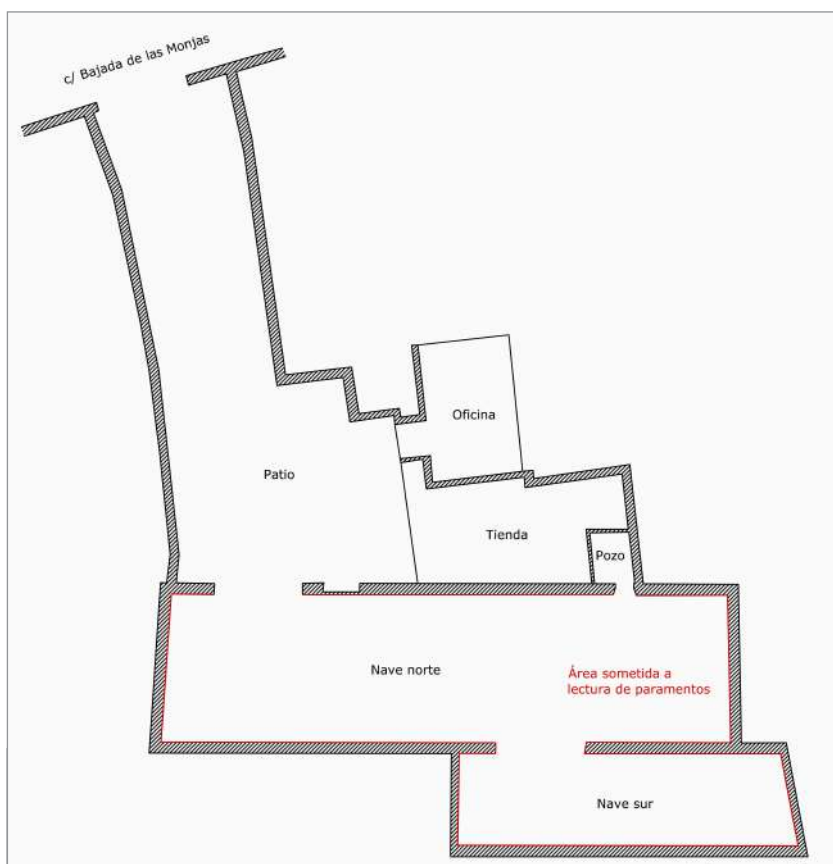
Planta de los edificios objeto del proyecto de rehabilitación.
